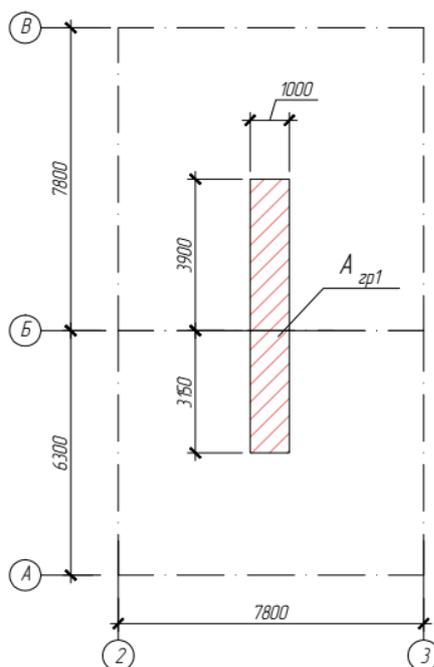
Грузовая площадь на обрез фундамента в осях Б/2-3
